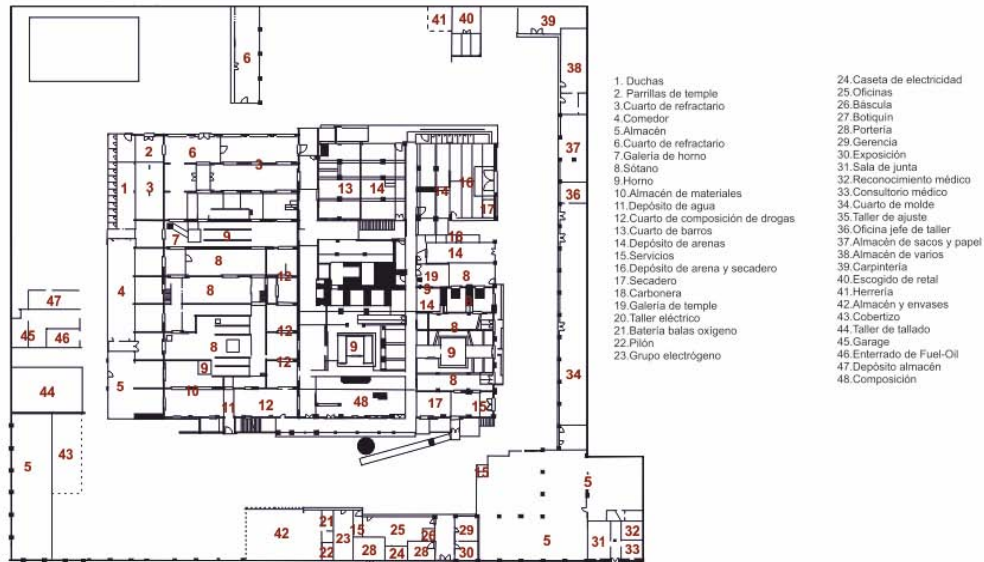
Distribución en planta: Planta baja en 1956
